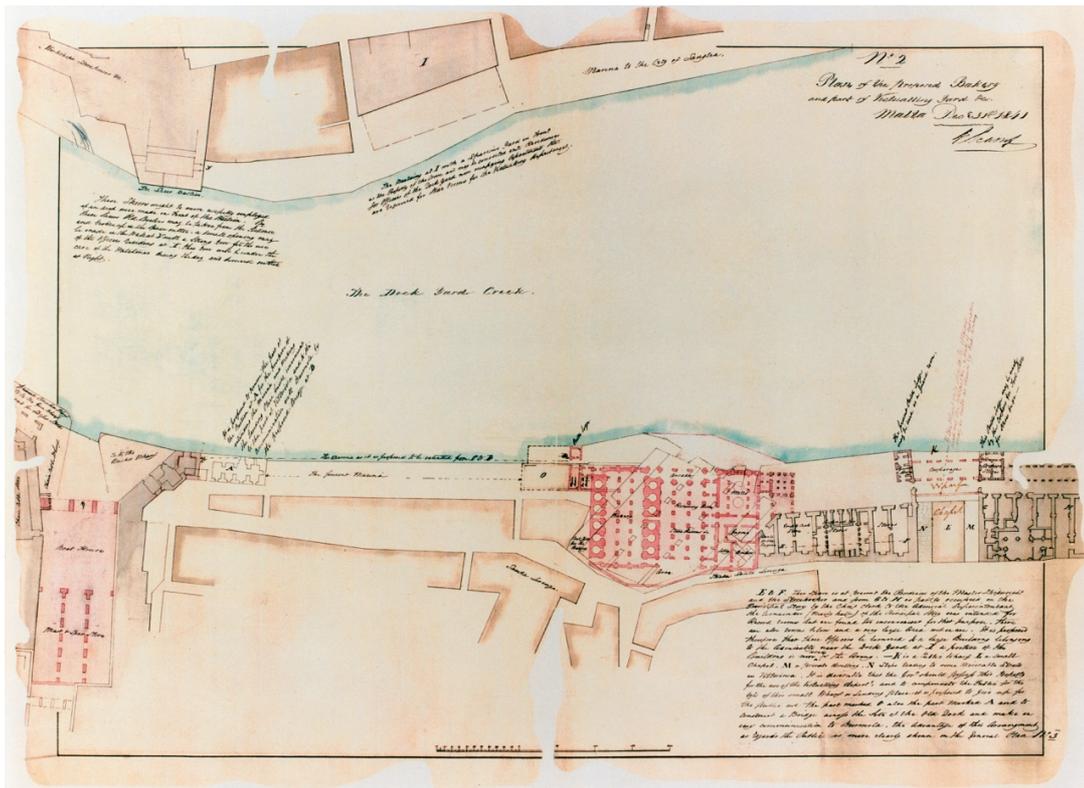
Stralcio della planimetria di progetto del Naval Bakery, in cui Scamp riporta la pianta dell'arsenale dei Cavalieri Ospedalieri, 1844. Fonte: The National Archive of Kew. Cortesia di C. Thake
